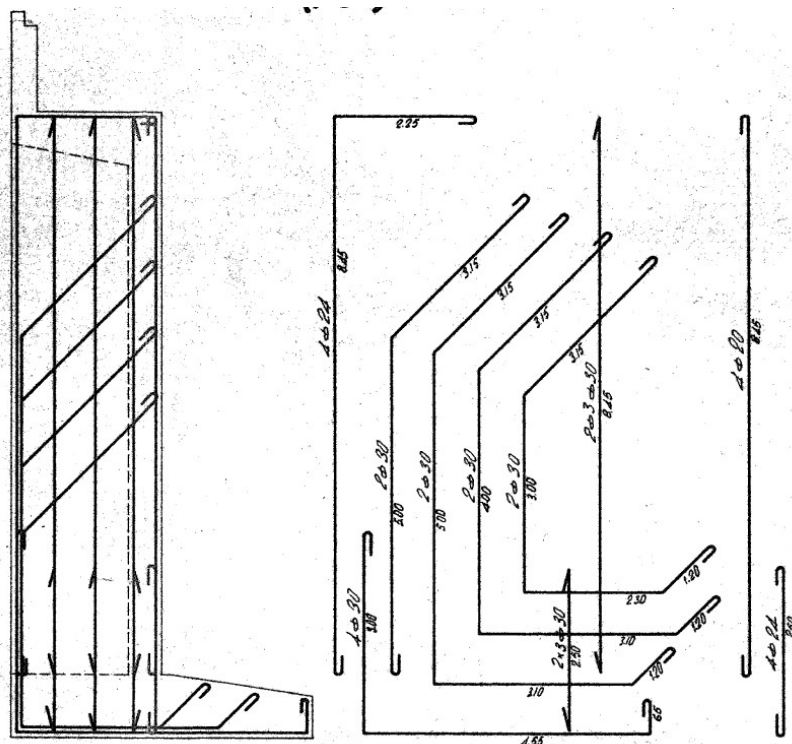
Documento as-built “Viadotto rampa interconnessione dell’autostrada A14 al km 14+346” – Sezione trasversale con armature contrafforti.
